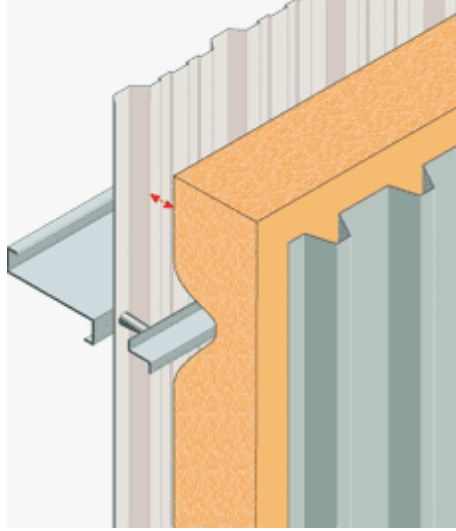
Dıştan yalıtımlı metal giydirme cephe elemanı [5]
